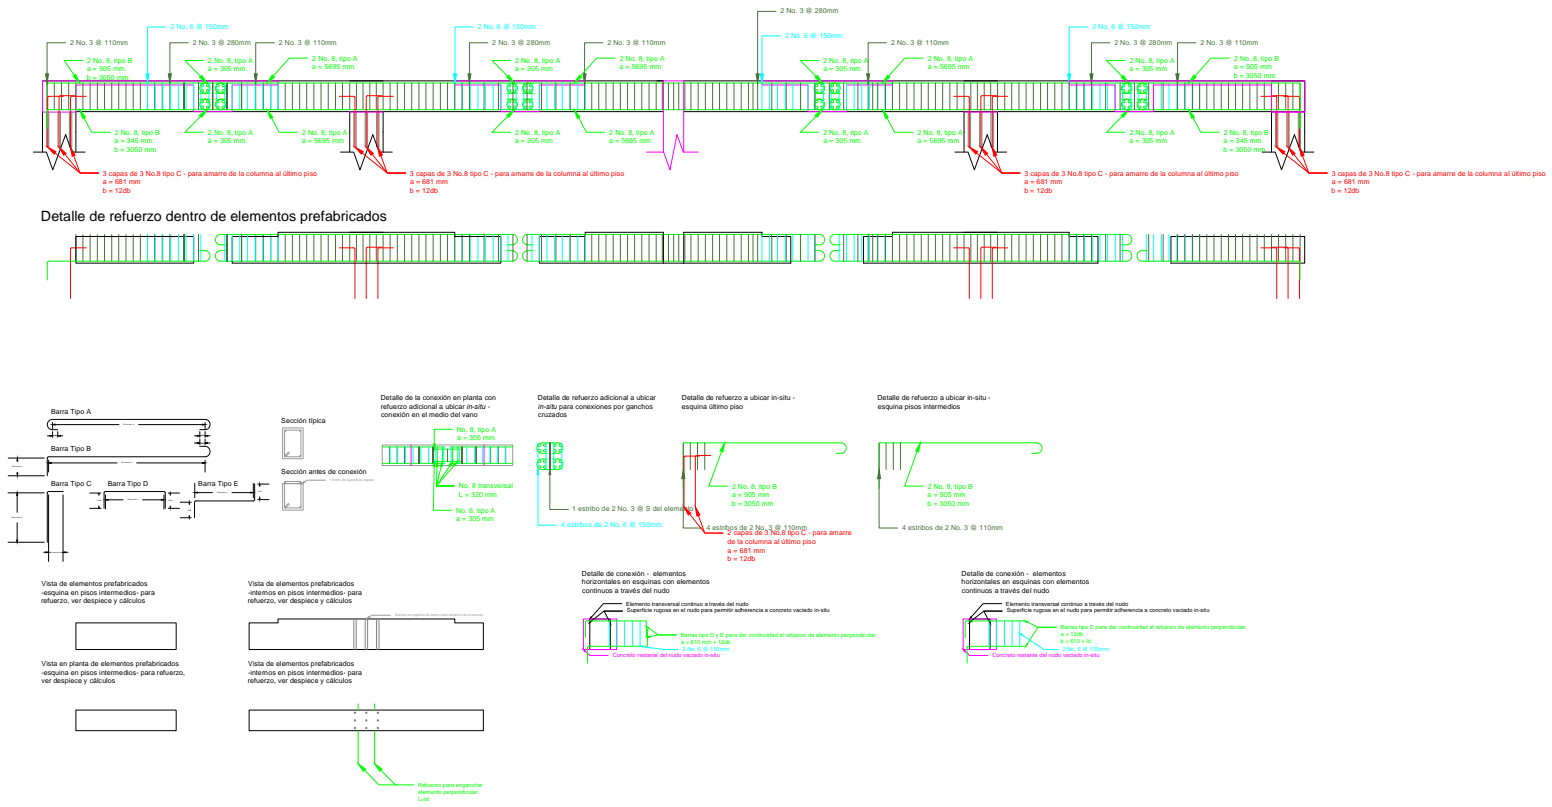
Despiece y detalle de conexiones para las vigas, edificación de gran altura. Nota: en magenta se presenta el concreto vaciado *in-situ*.
